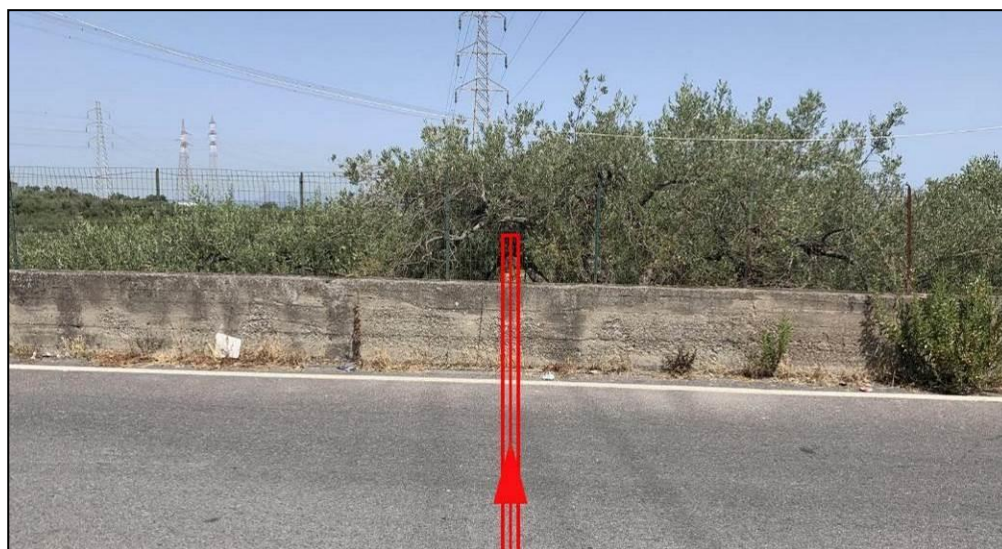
/E – Vista senso gas dell'attraversamento Via Pizzocroce (S.P. n.66) in trivellazione
